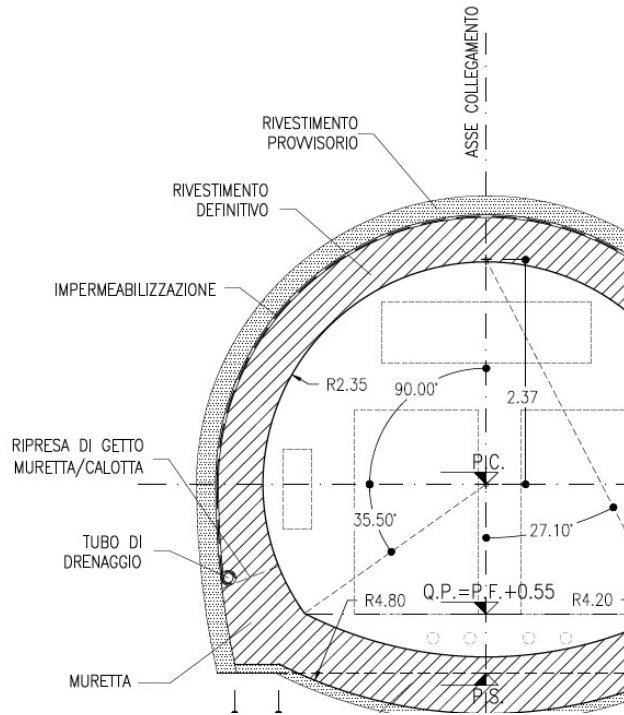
Sezione di intradosso bypass pedonale (sezione corrente)
